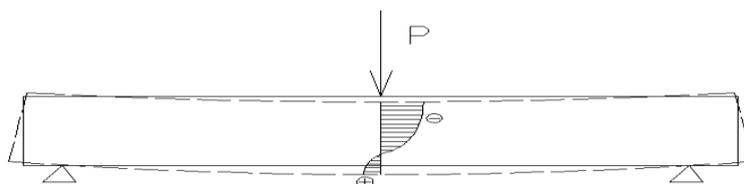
Бетонная балка, эпюра напряжений в сечении
